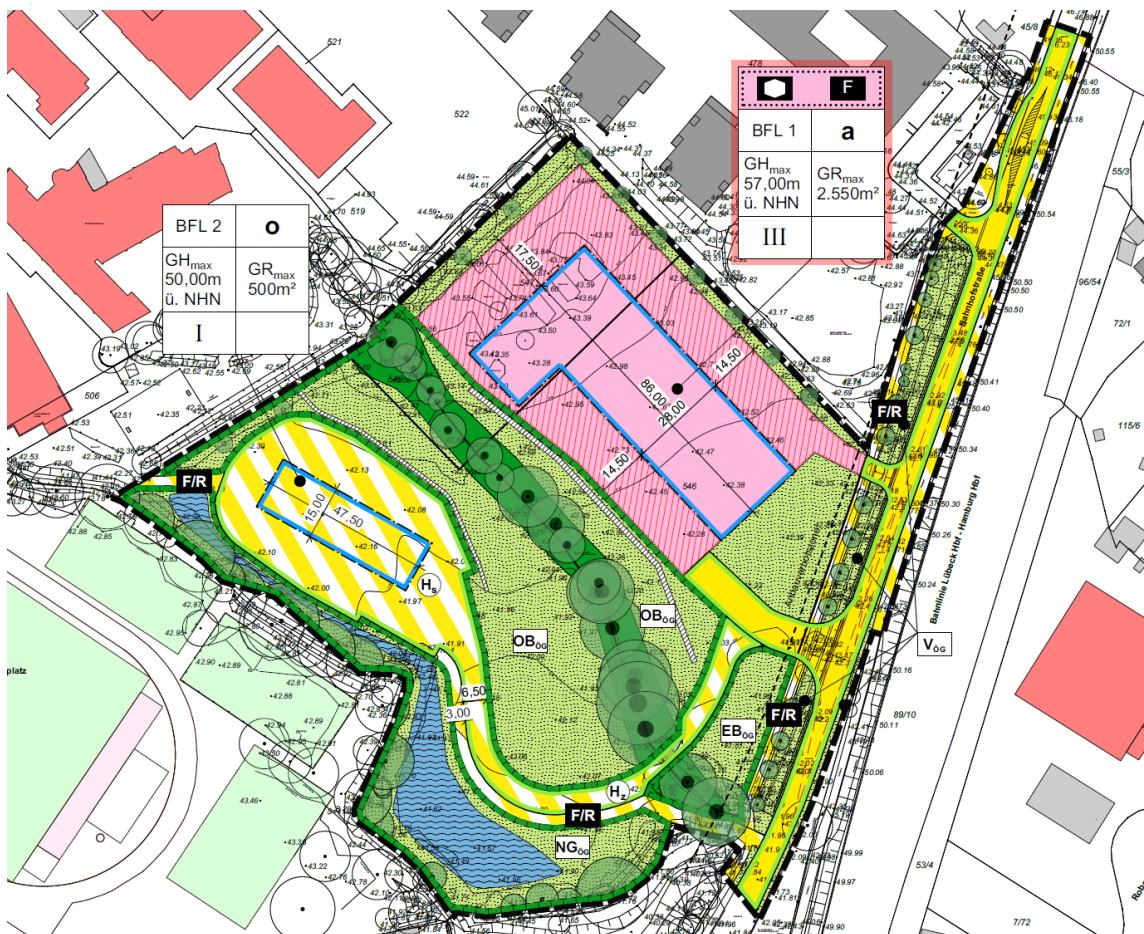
Planzeichnung B-Plan Nr. 9b (B2K, 2023)
